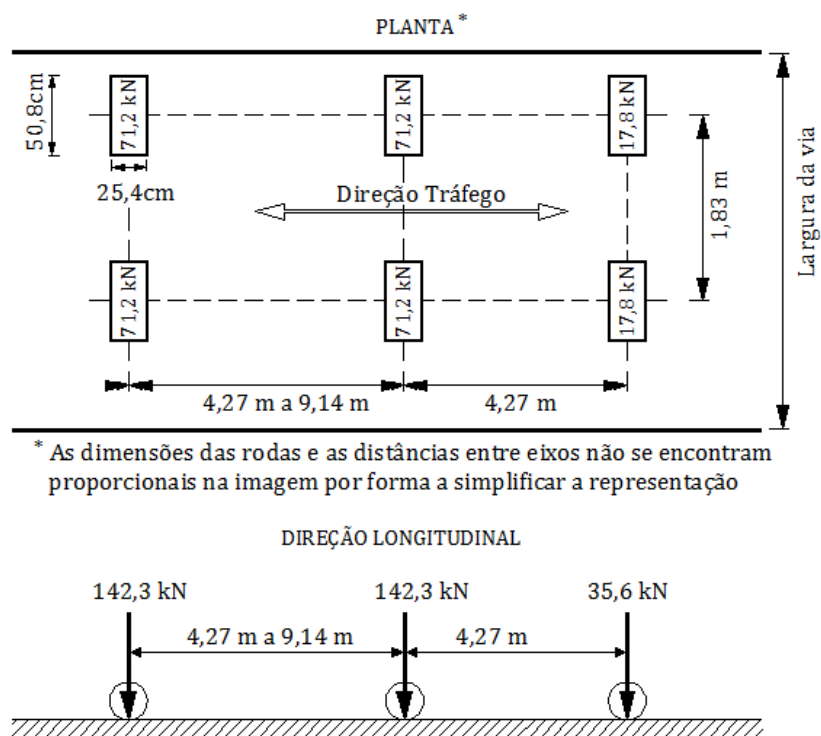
Truck* (HS20-44) em planta e na direção longitudinal
